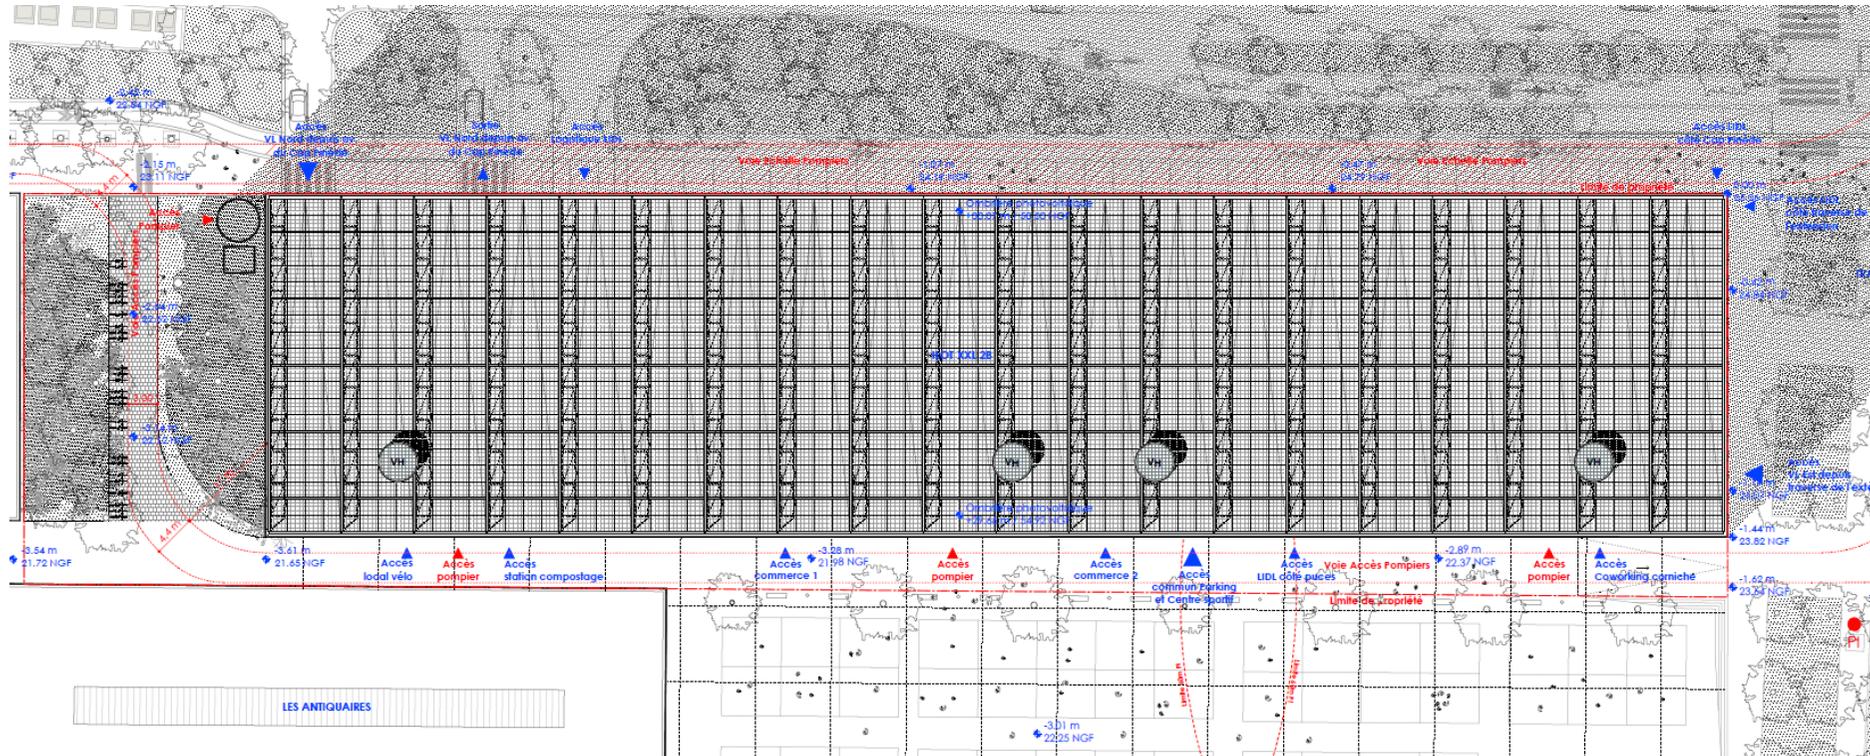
Plan masse du projet d'îlot 2B (ANNEXE 04)
